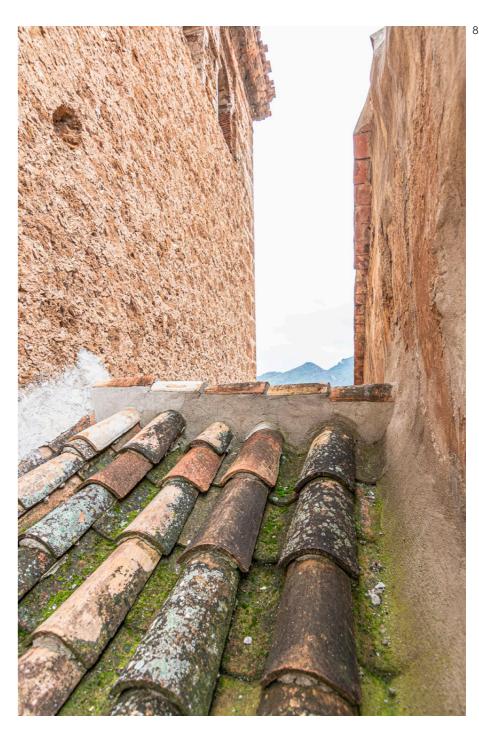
Cubiertas volúmenes patio inferior. Imagen (8.21) Cumbrera del volumen adherido a la torre.
